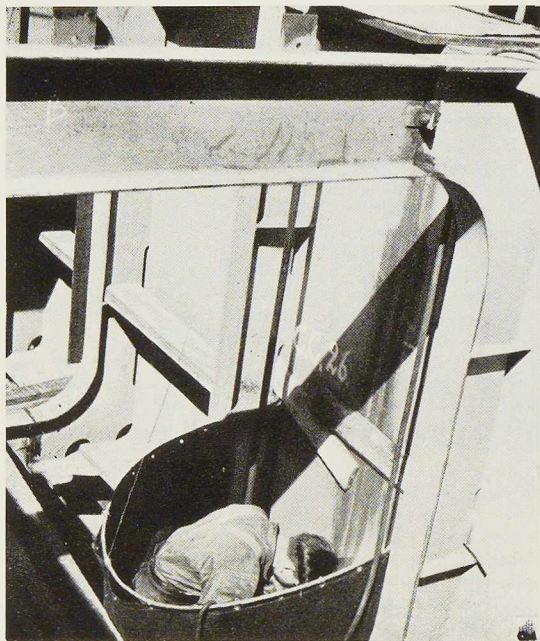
Exécution d'une soudure à une maîtresse poutre. On note les bâches protégeant le soudeur.
